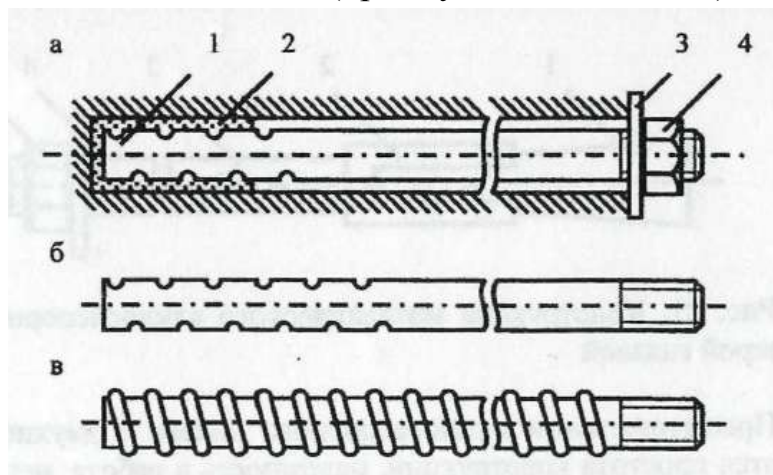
Конструкция сталеполимерного анкера: а – анкер, установленный в скважине; б – общий вид отечественного анкера; в – общий вид английского анкера
